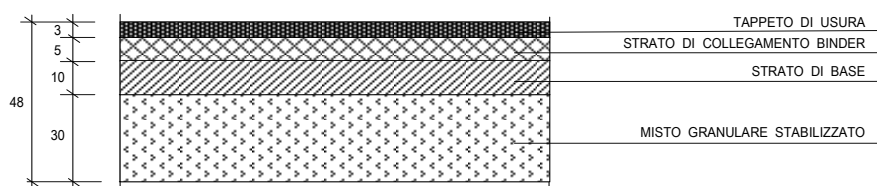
Pavimentazione stradale - Pista principale
